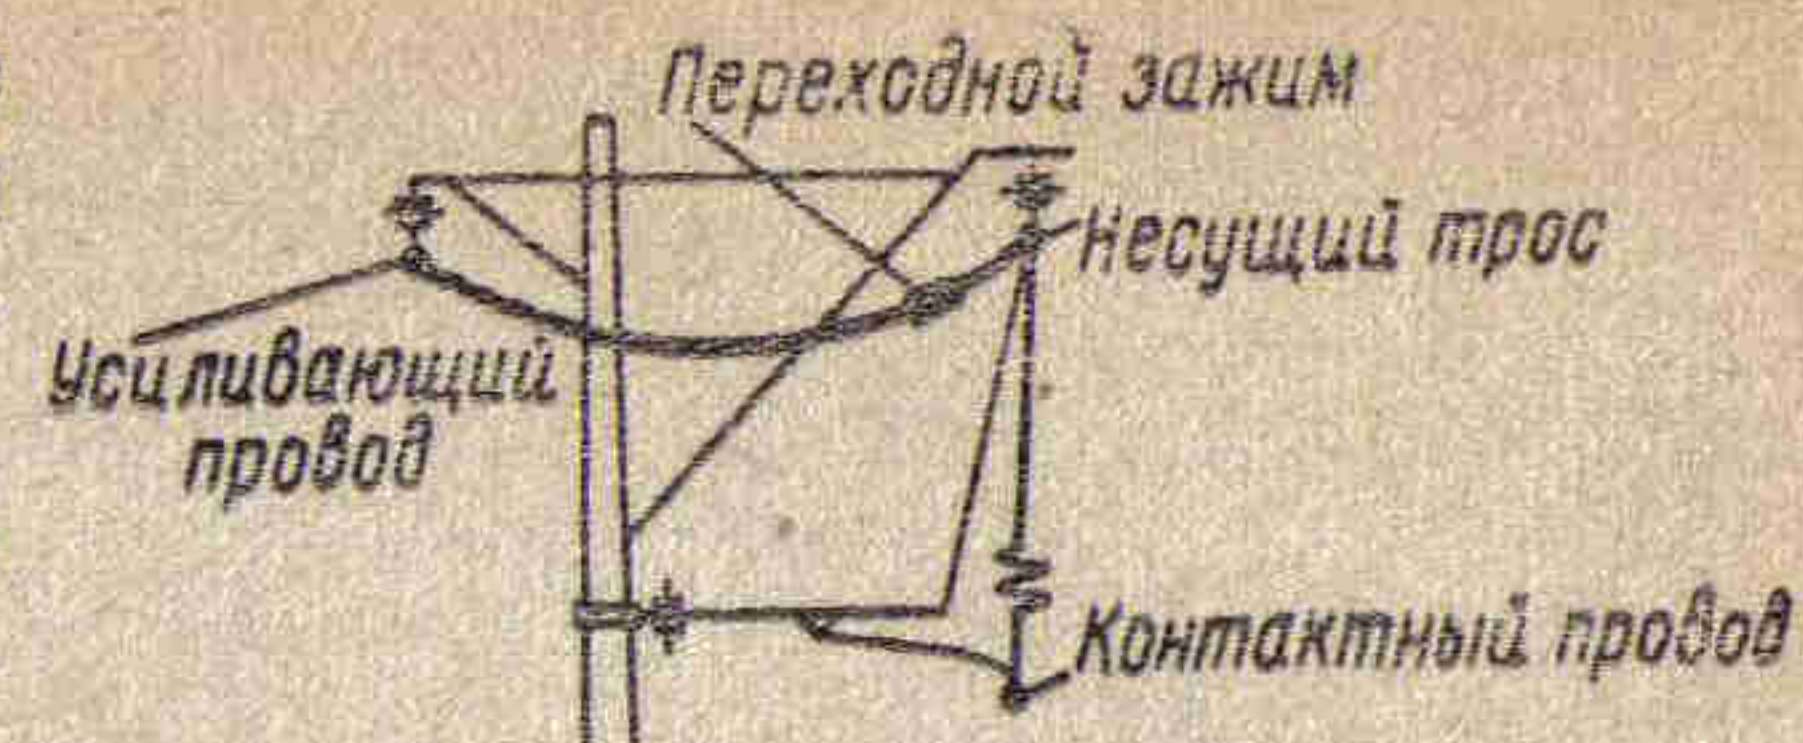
Схема поперечного соединителя при наличии усиливающего провода
